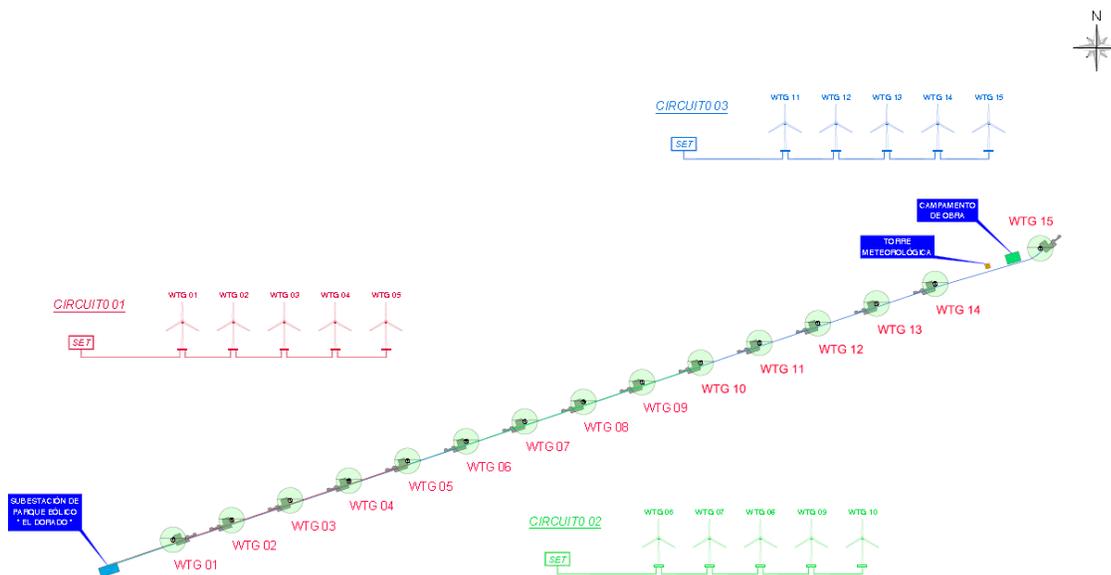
Vista en Planta - Parque Eólico El Dorado
